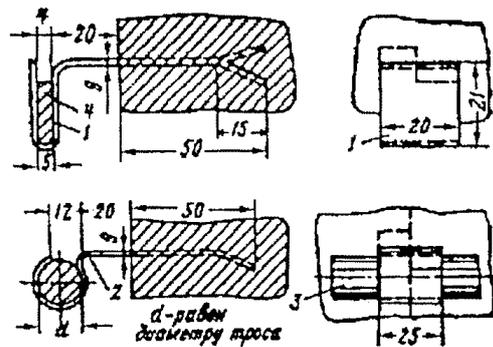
Крепление заземляющего проводника в камере с бетонной крепью: 1 - зажим для крепления плоских шин; 2 - зажим для крепления троса; 3 - трос; 4 - шина.
